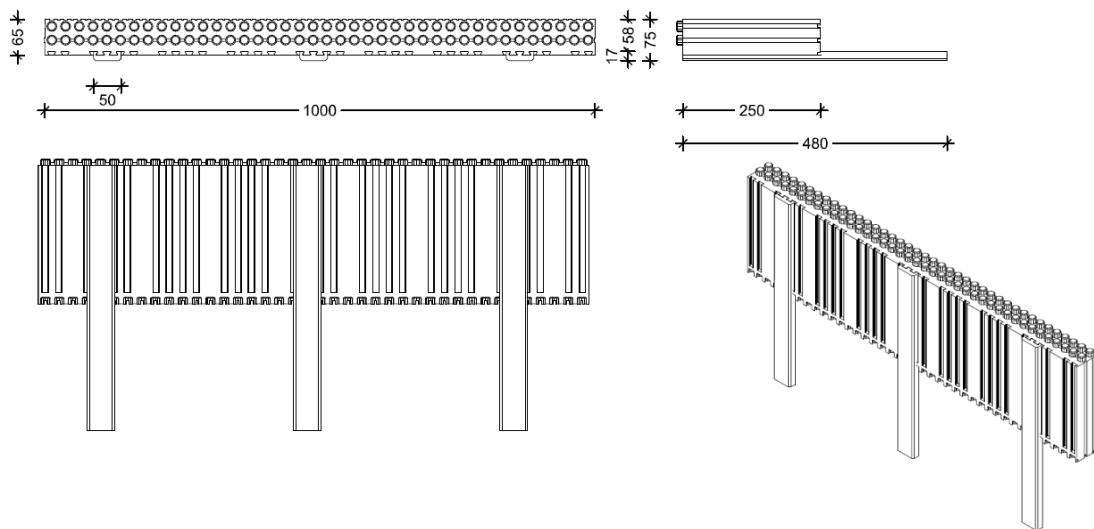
Dimensões de elemento de fecho de laje, em placas simples de bordadura com fixação de madeira (ARGISOL, 2010).
